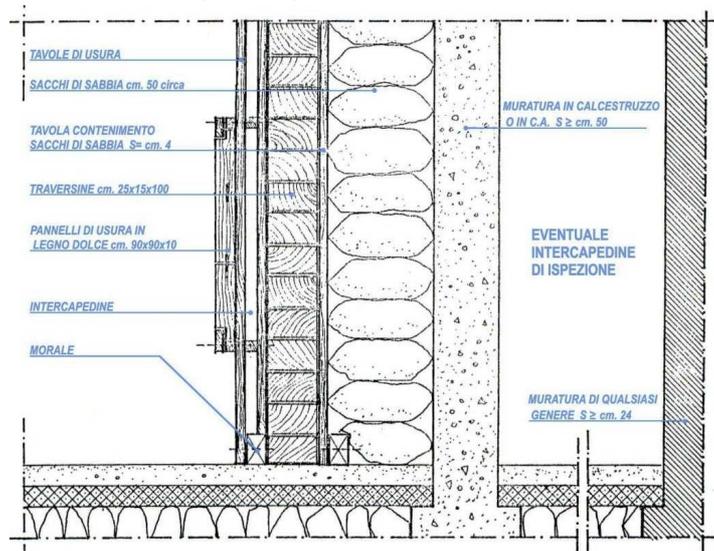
Sezione di un parapalle tradizionale in muratura, con rivestimento in legno
